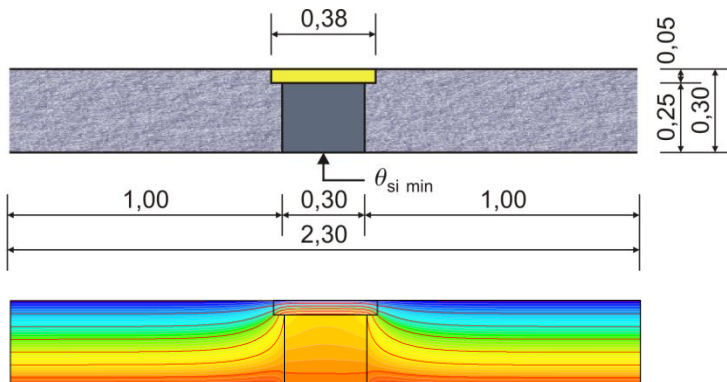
Детайл $W2$. Стена от клетъчен бетон с колона без топлоизолация – схема и изотерми
